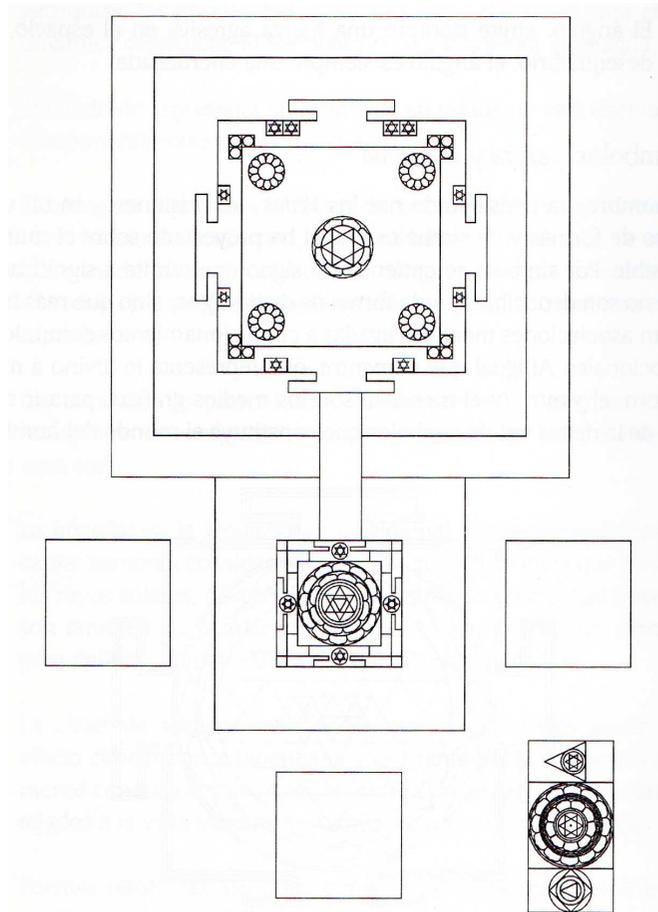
Planimetría templo Parama Surya. Hach G.(2002).
